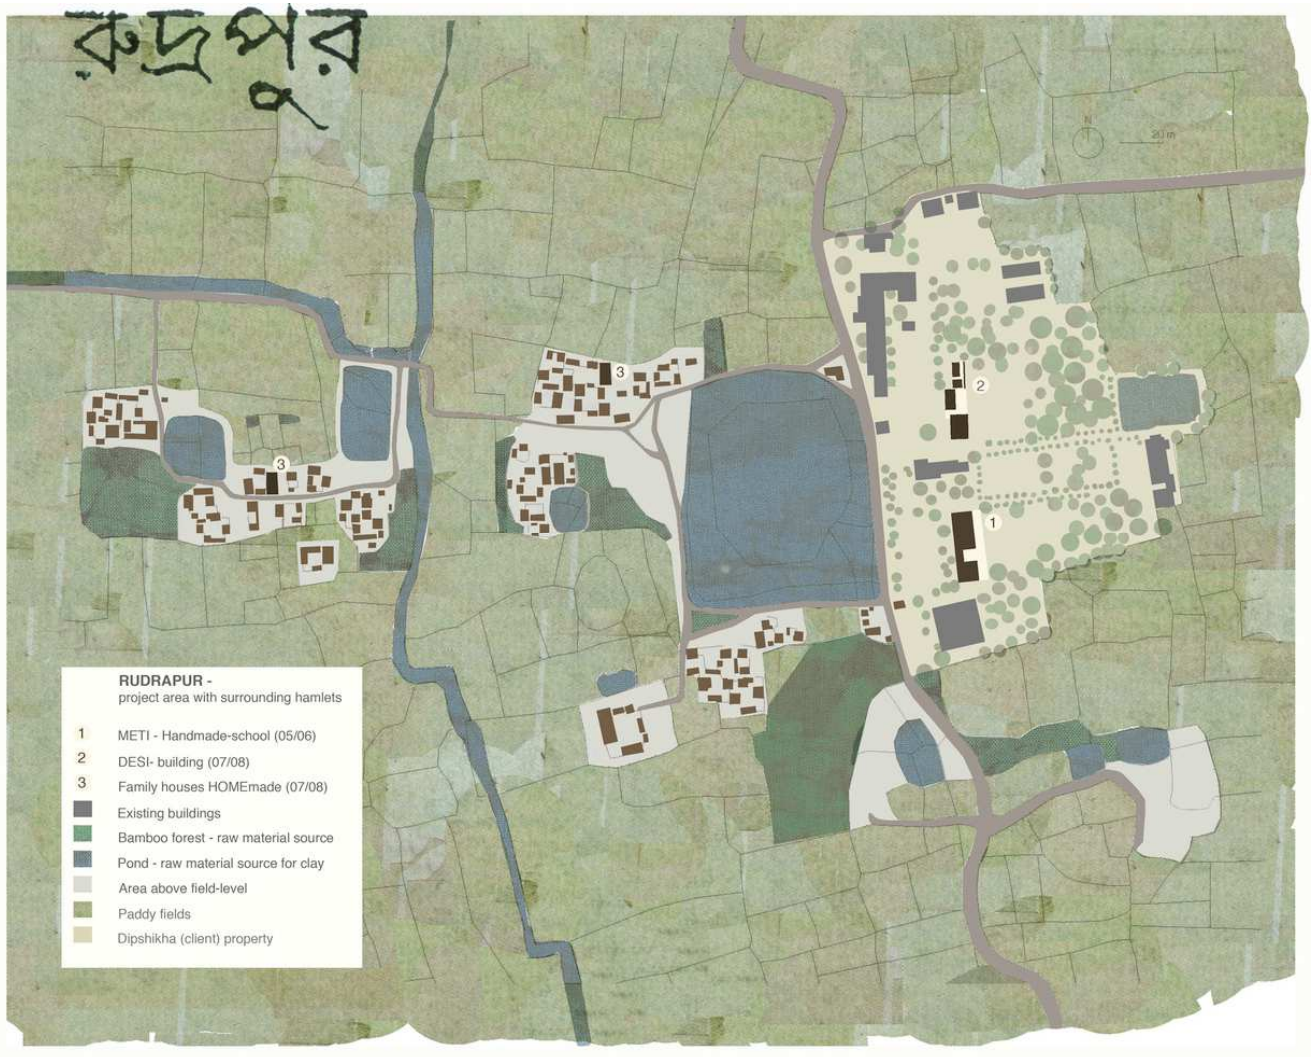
Plan directeur de Rudrapur avec le projet Desi Training Center.
